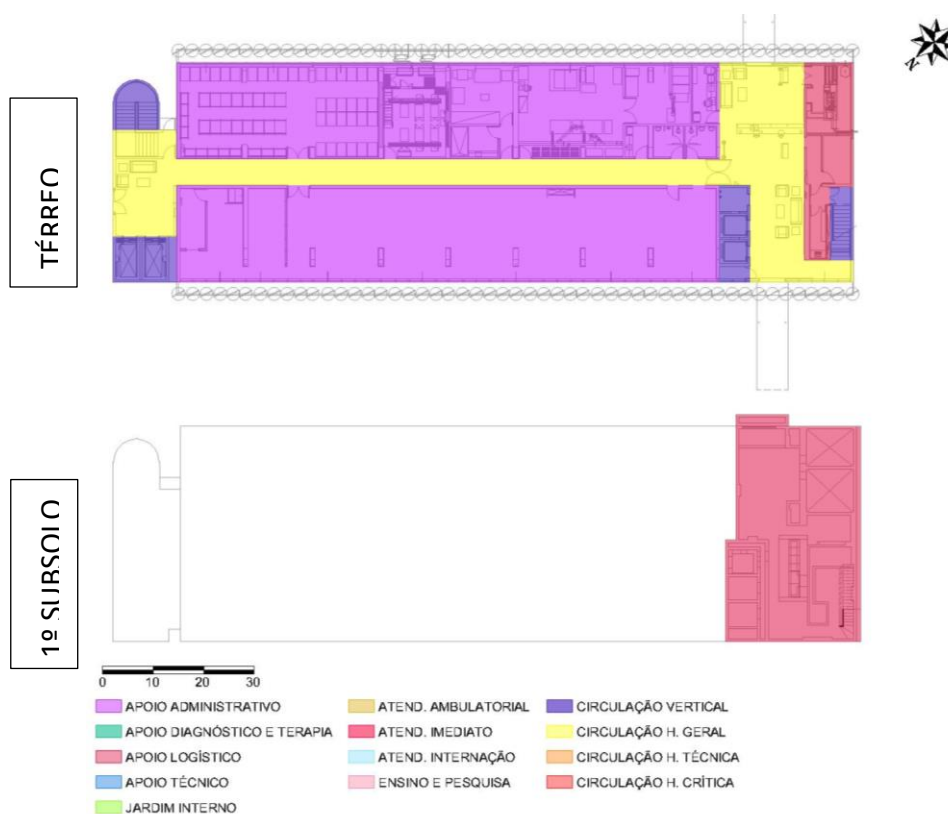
Setorização Edifício Sede, 1º subsolo e pavimento térreo.
